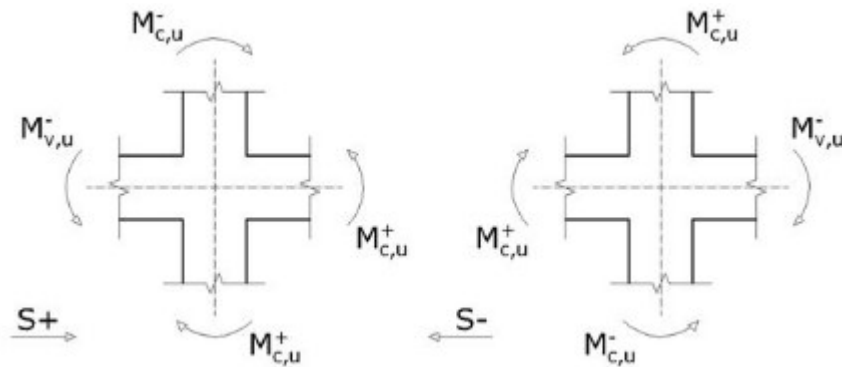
Mecanismo tipo pilar fuerte – viga débil
